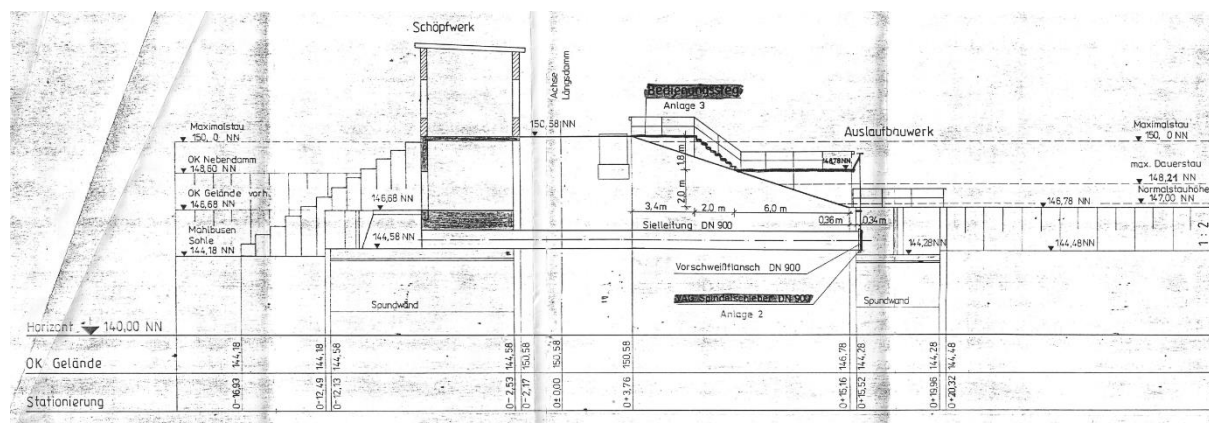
Auszug aus dem Plan 5.3/1 „Lageplan 1 – Sielleitung“
